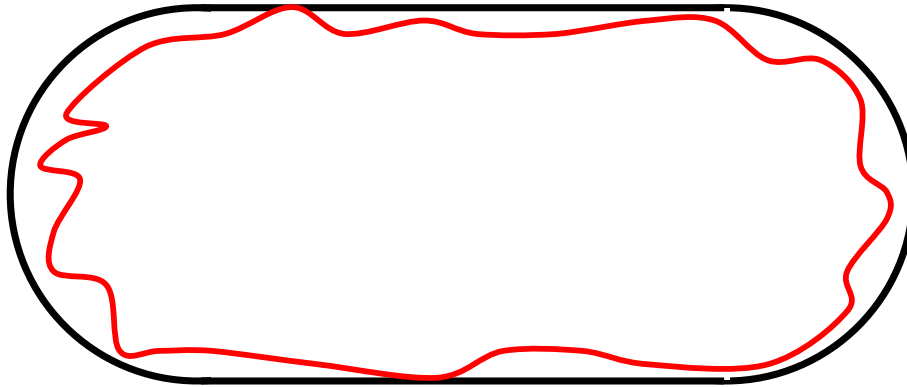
Schematischer Grundriss einer Kaverne: Für die Modellierung angenommene abdeckende Einhüllende (schwarz) und tatsächlich vorhandene Kavernenkontur (rot)
